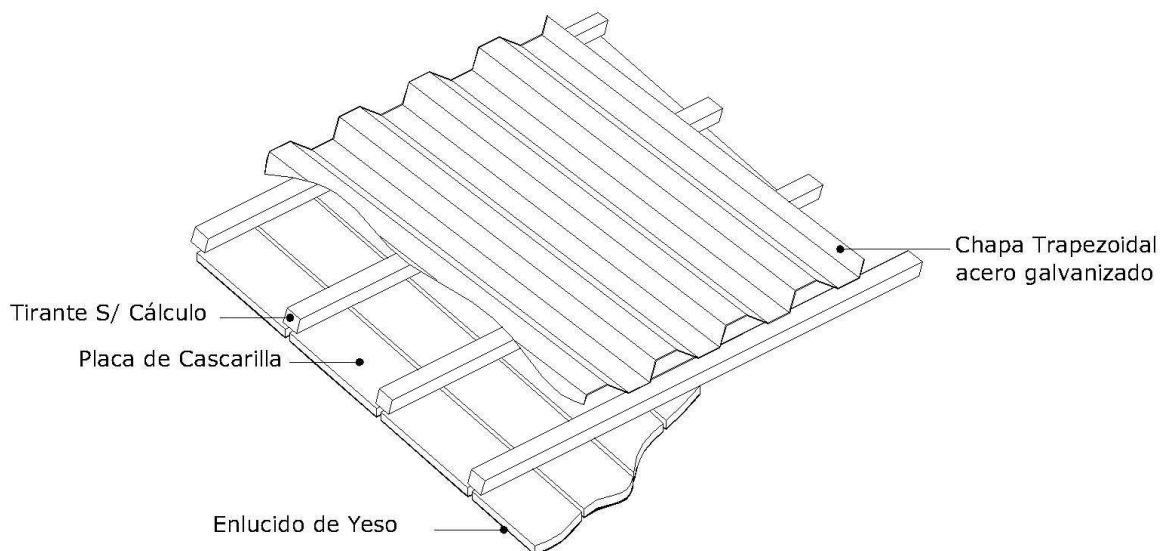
Cubierta de chapa galvanizada trapezoidal tipo T-98, montada sobre tirantería de madera con cielorraso constituido por placas de aglomerado de cascarilla de 50 mm de espesor atornilladas a los tirantes de madera tratadas en su superficie superior con una pintura impermeabilizante y en la superficie inferior mediante la aplicación de un enlucido de yeso de aproximadamente 5 mm de espesor.
